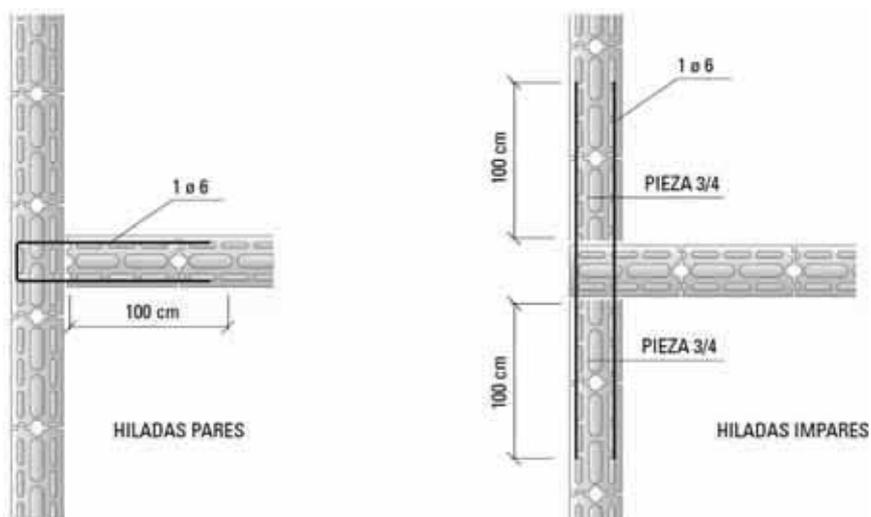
Encuentro de fábrica no armada de muros de bloque aligerado.
